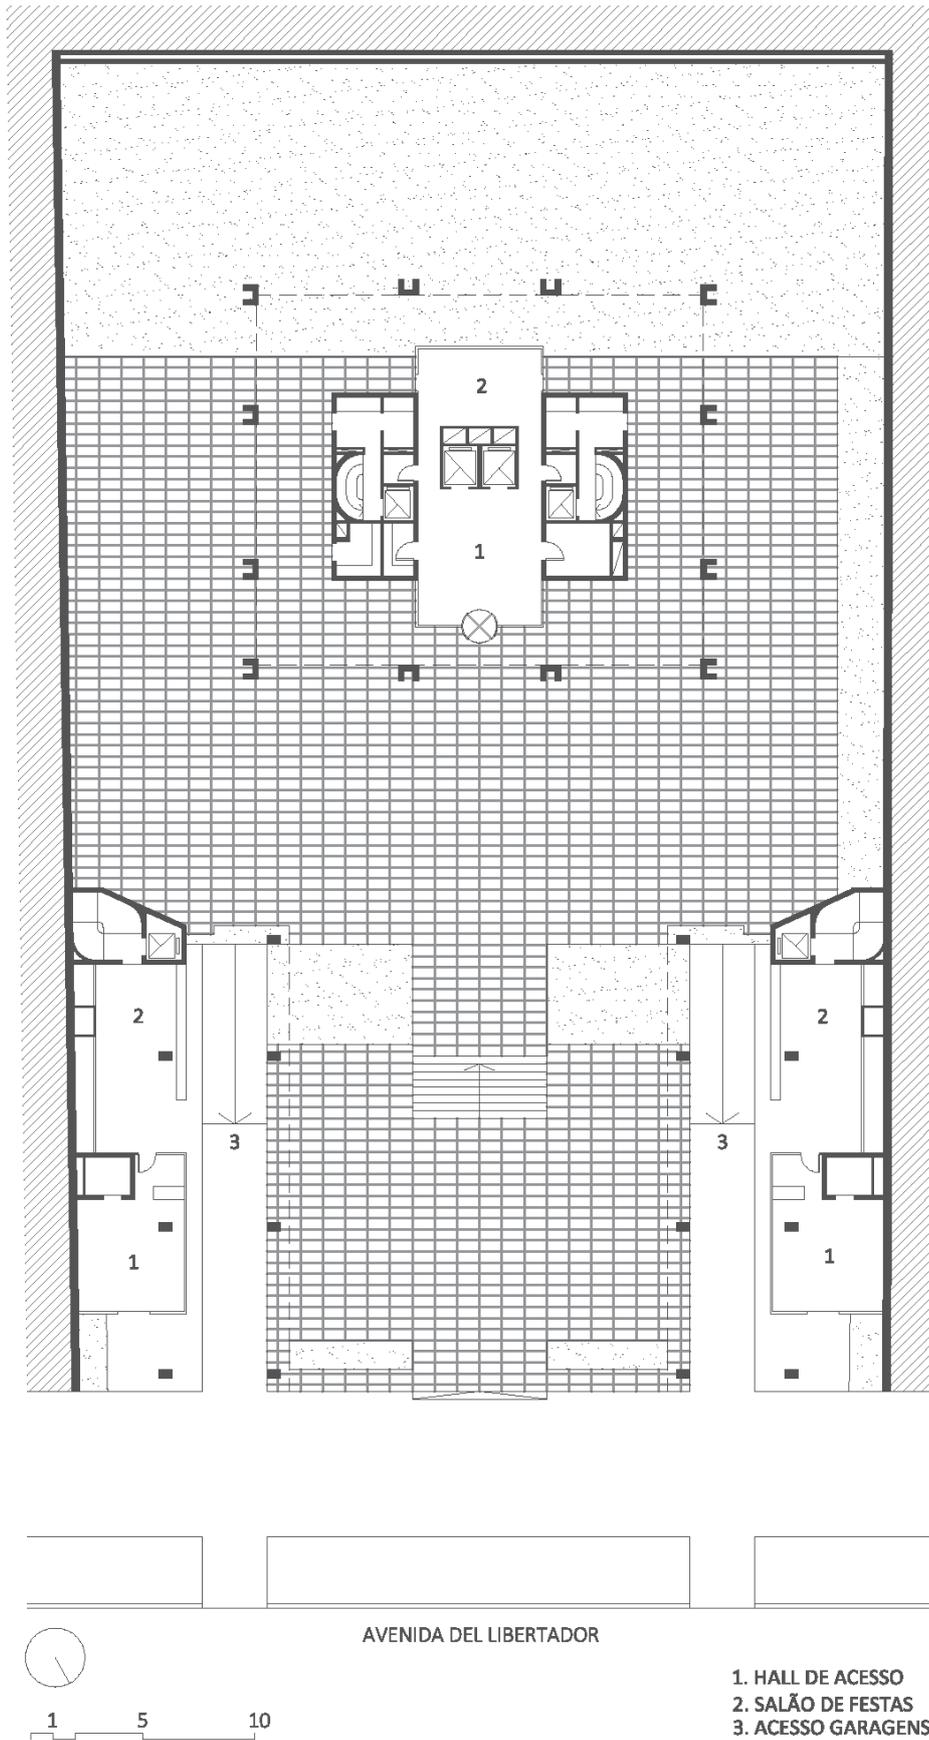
Planta Térrea. Edifício Panedille, 1964-1969.
